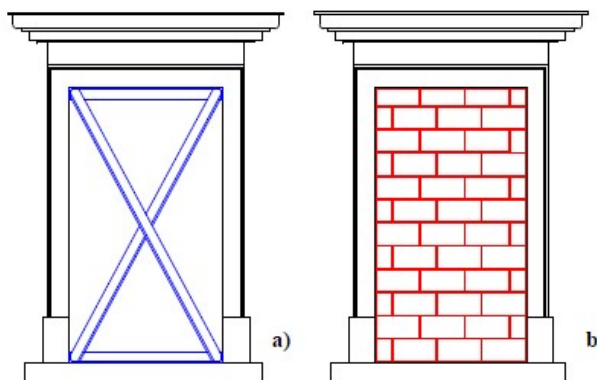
Reforço dos vãos: contraventamento utilizando peças de madeira ou tamponamento com blocos de alvenaria
